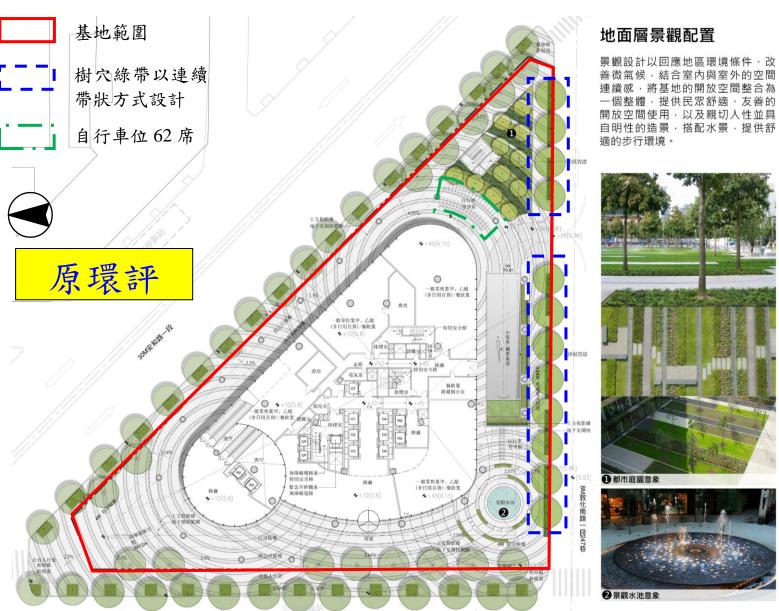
1F 平面景觀配置及動線示意圖(原環評)
